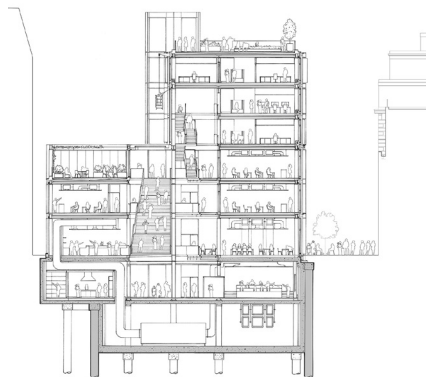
Новое здание LSE Centre Building. Поперечный разрез
